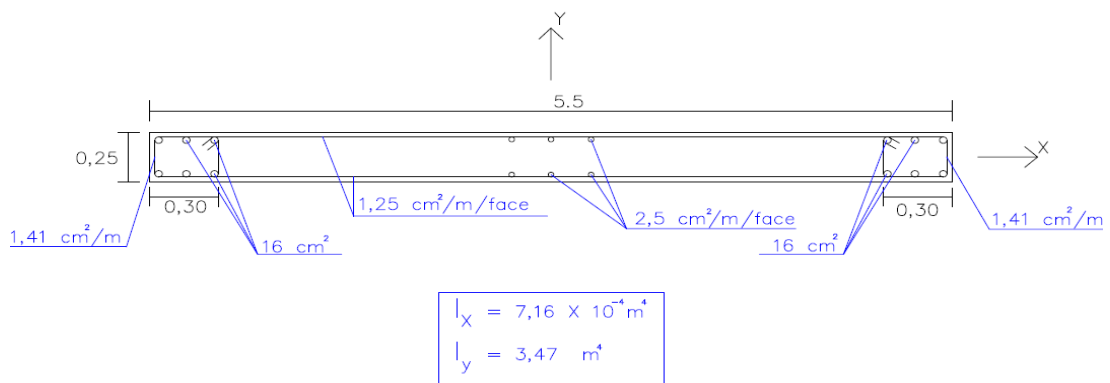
Pormenorização das armaduras adotadas para as paredes de betão armado.
